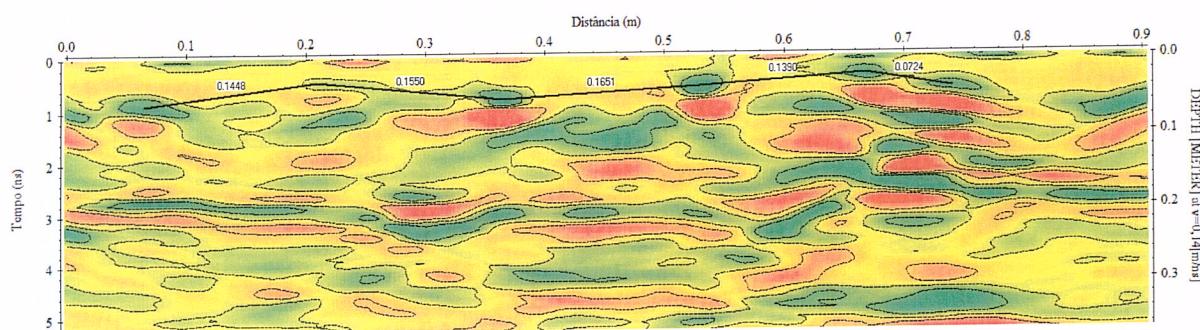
Radargrama da seção vertical tomada na face oeste da Viga 2. Identificados refletores associados a barras de armadura longitudinal espaçados entre si a 14, 16, 16, 16, 14 e 7cm.
